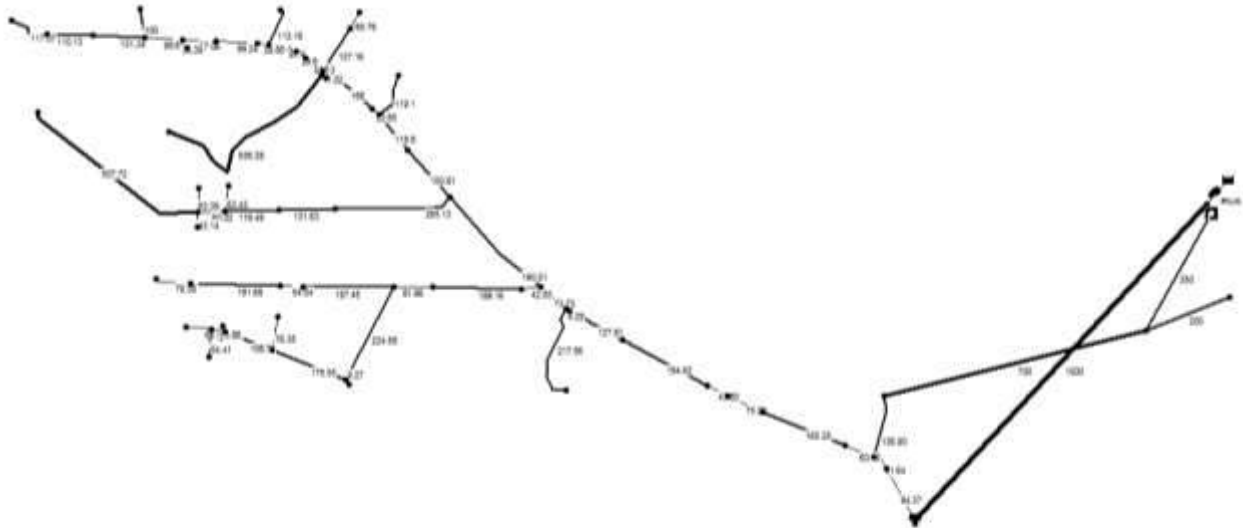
Plan du réseau avec l'indication sur les longueurs de conduites en m
